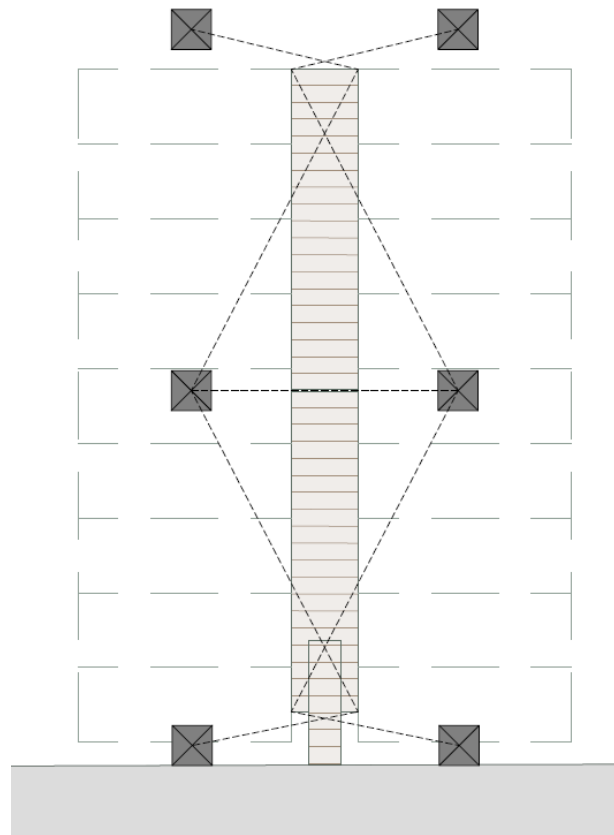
Schema tipico di ancoraggio di un pontile galleggiante. Vista in pianta
